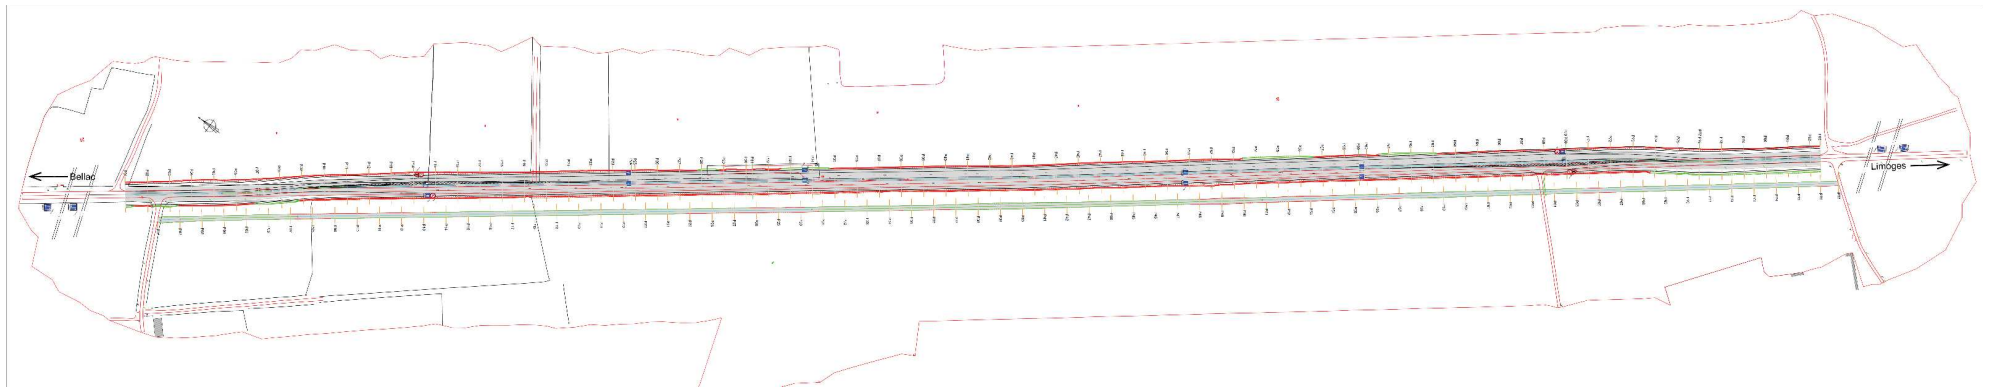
Berneuil créneau en place élargissement coté Est, vue en plan
